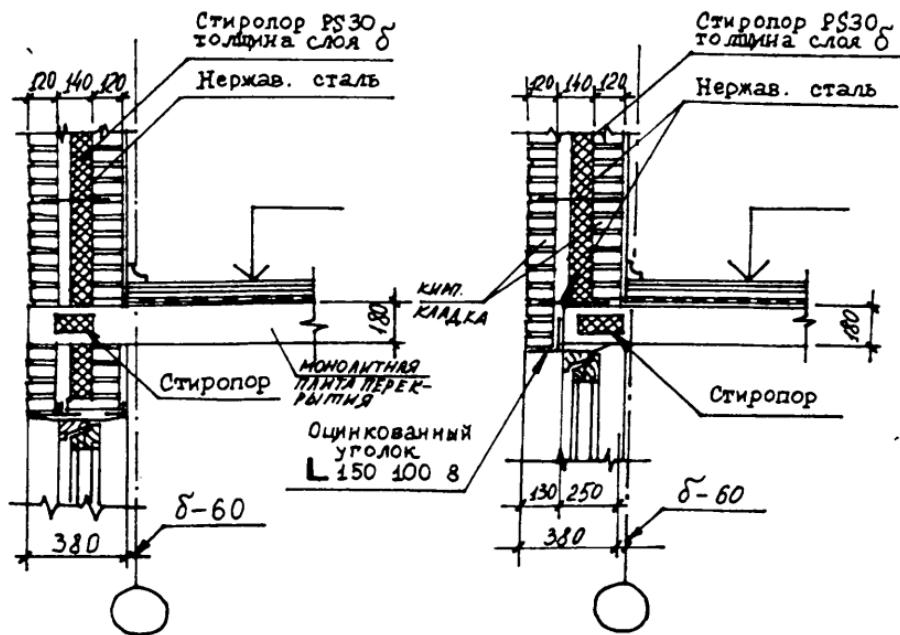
Детали опирания многослойных кирпичных стен на перекрытия каркасных зданий
